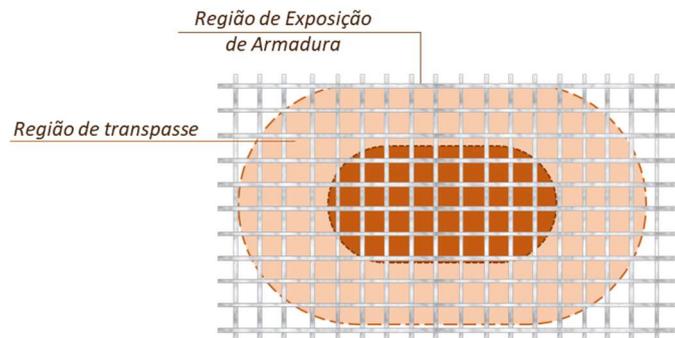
Esquema de exposição do concreto em perímetro de recuperação;
